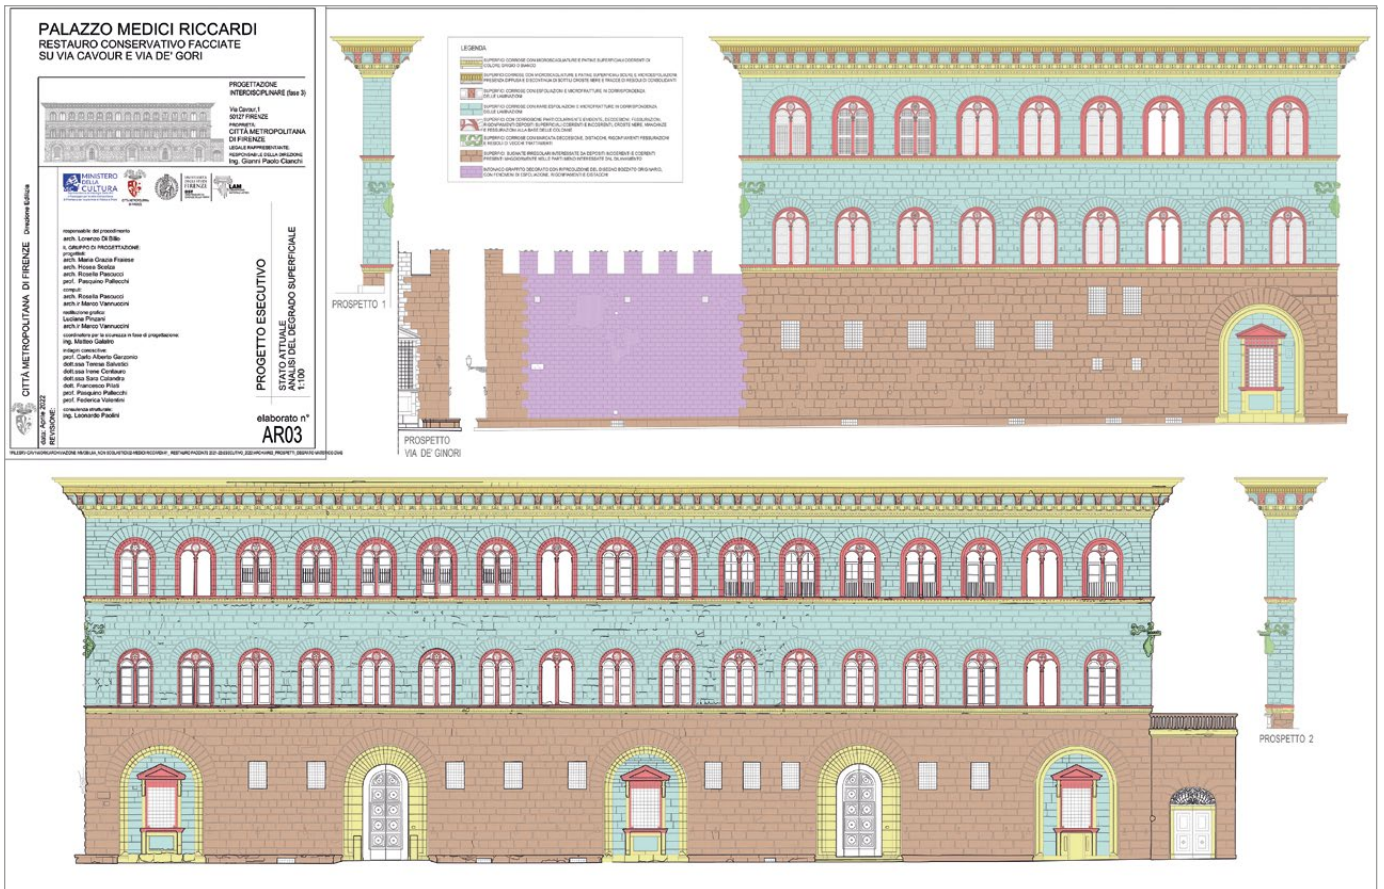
Tavola estratta dal progetto esecutivo. Rappresentazione sintetica dei fenomeni di degrado sul prospetto di Palazzo Medici-Riccardi lungo via Cavour.
